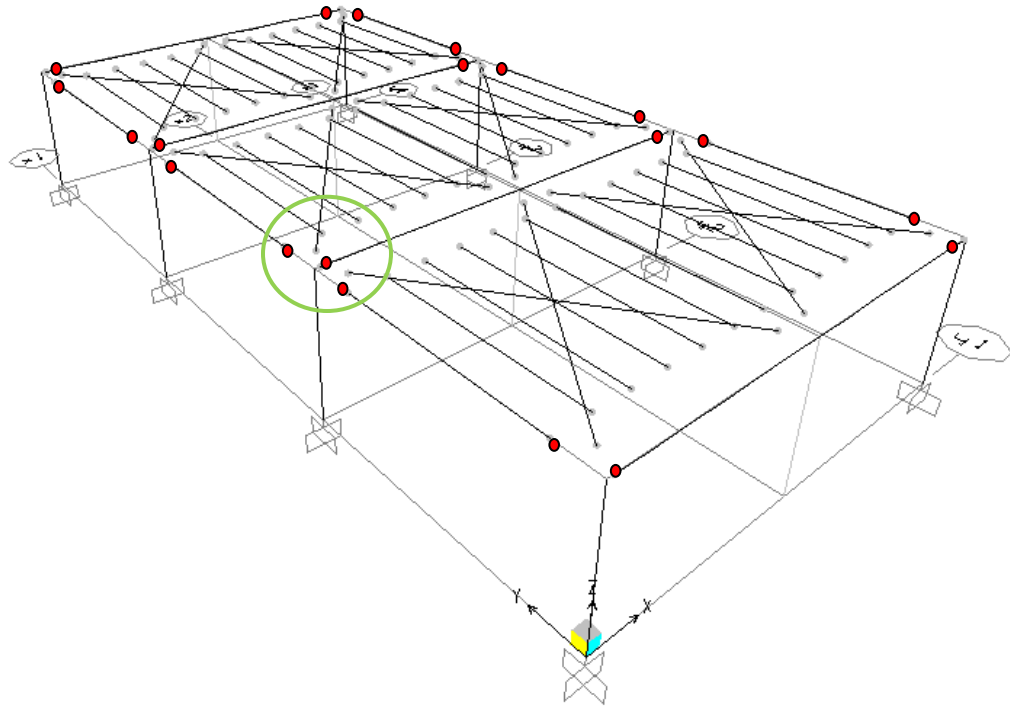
Nave industrial con conexión viga – pilar rotulada
